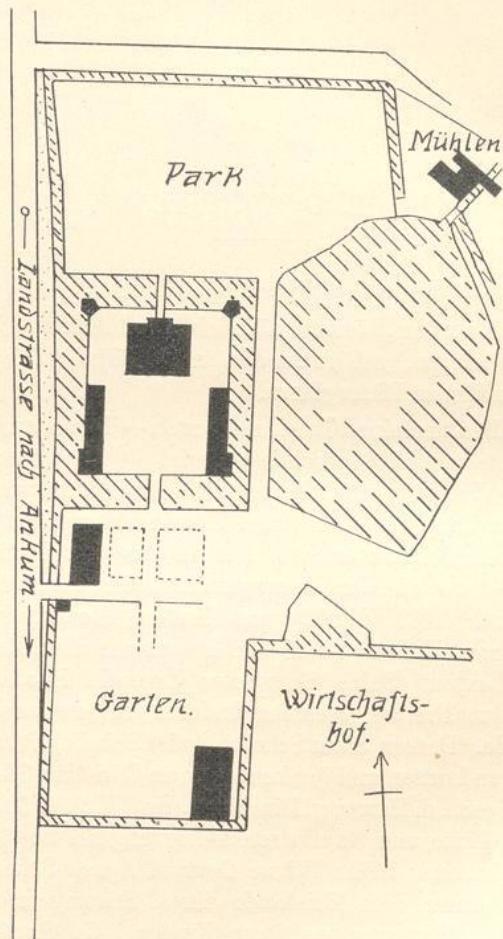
Haus Loxten: Lageplan (1: 5000).
